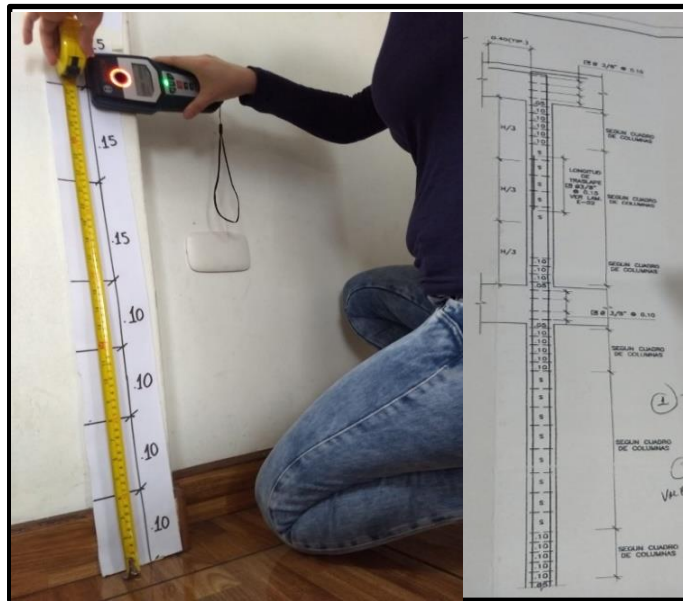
Ubicación de acero de estribos en columna, detectado a cada .15m. como especifica en el cuadro de columnas.
